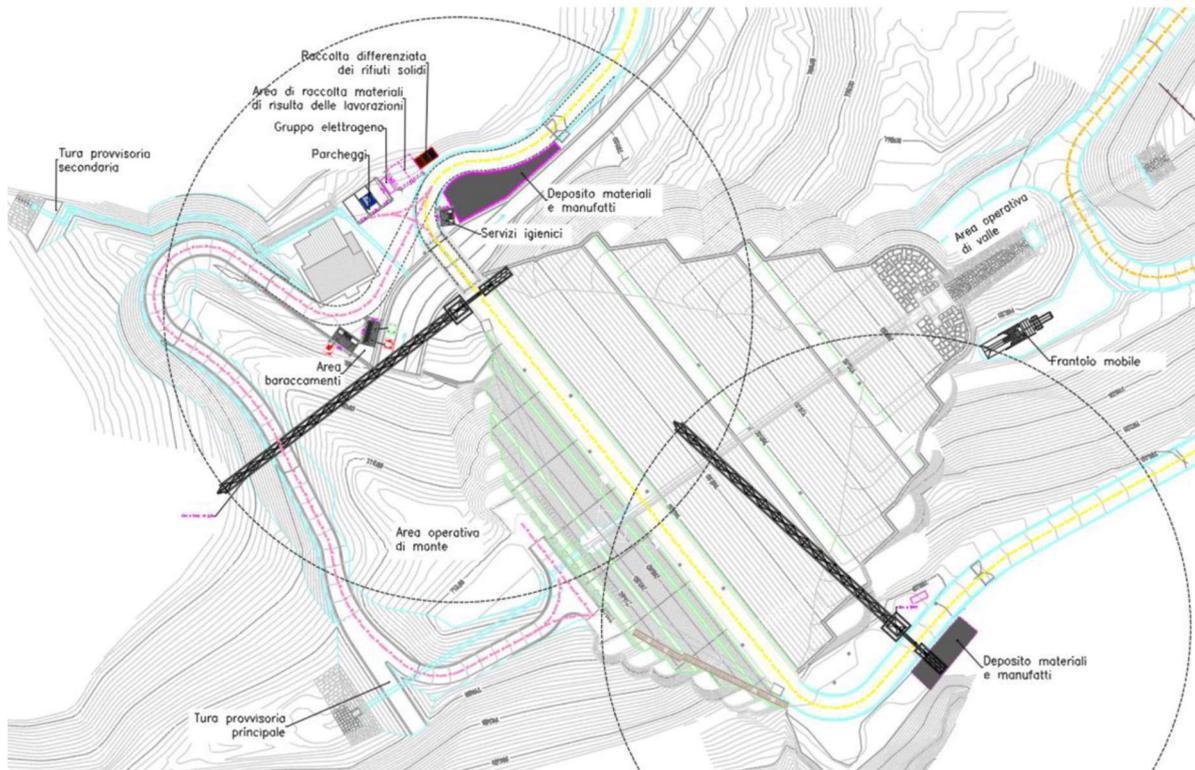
Planimetria aree di cantiere in corrispondenza dello sbarramento
